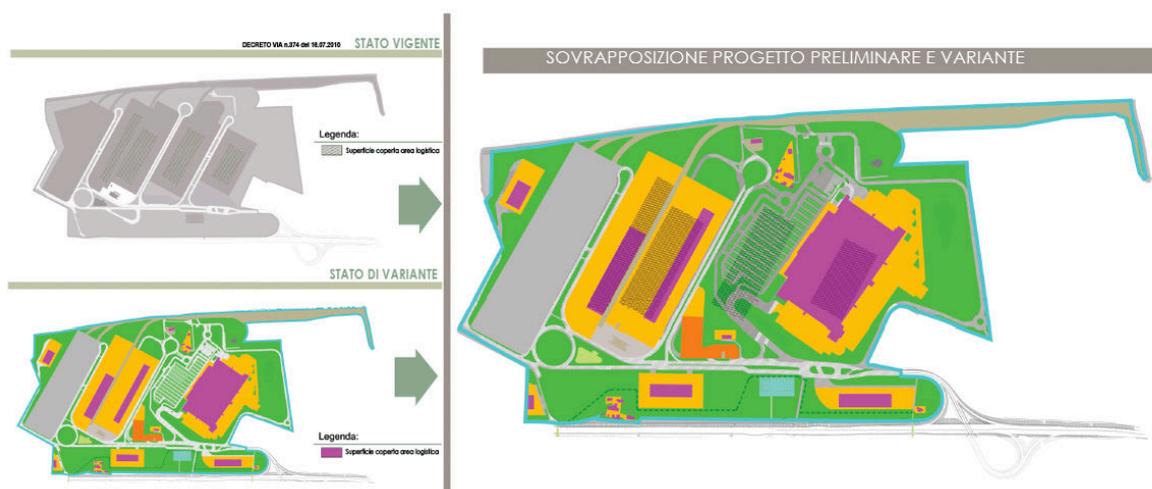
Planimetria Planimetrie di confronto stato vigente (VIA 2010) e stato di variante e sovrapposizione dei due scenari
